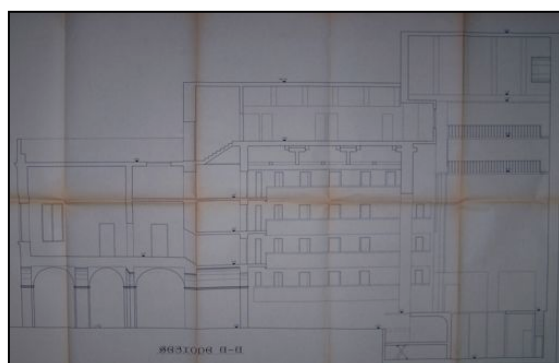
Benevento, teatro V. Emanuele. Sezione longitudinale, progetto di restauro, 1994 (archivio privato Giangregorio): si noti la differenza con la sezione nella sezione a lato (fig.8) in cui è visibile il vuoto al di sotto della platea.
